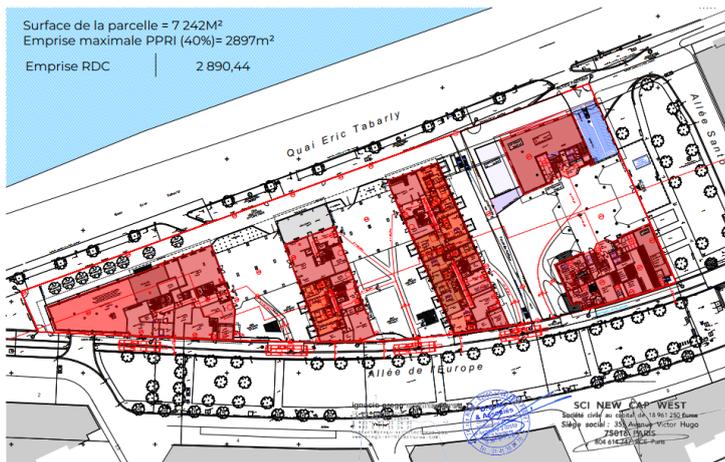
Plan des rez-de-chaussée - Source : document PC04
